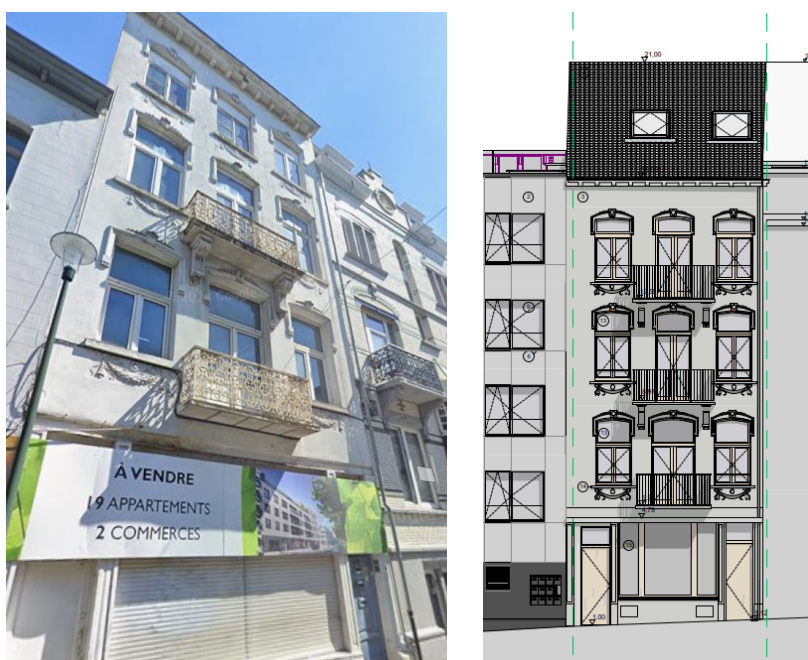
Façade étudiée - Extrait de Google Maps (gauche) – Extrait des plans d'architecture (droite)
